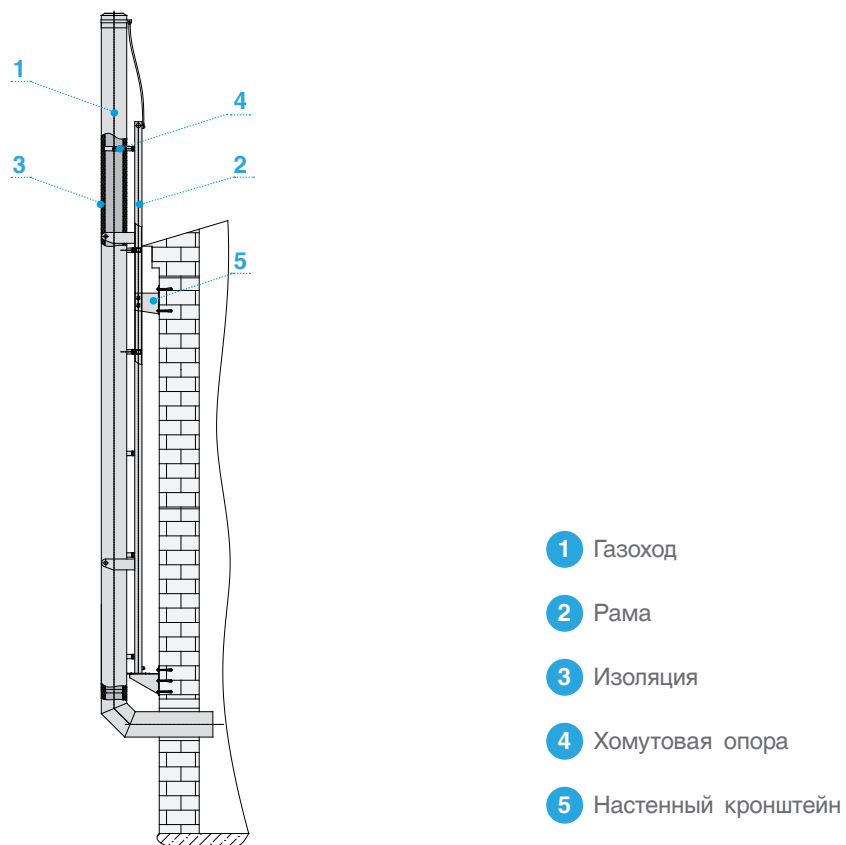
Схема конструкции дымовой трубы фасадного типа
